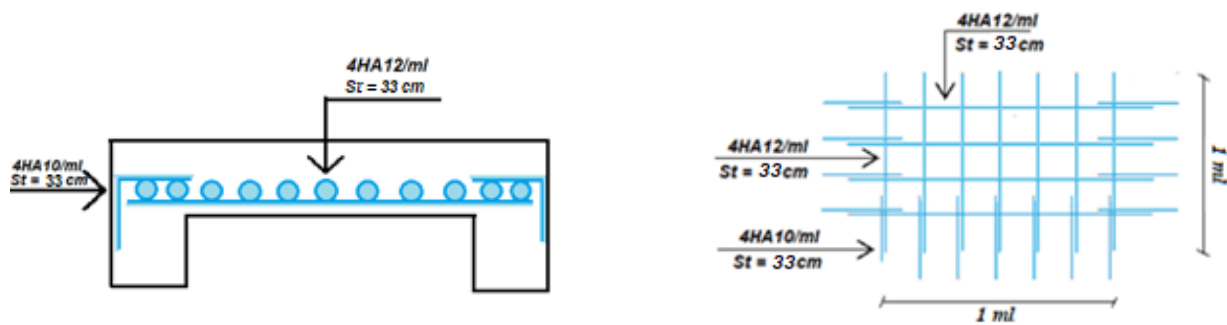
Schémas de ferraillages de la dalle plein D2
